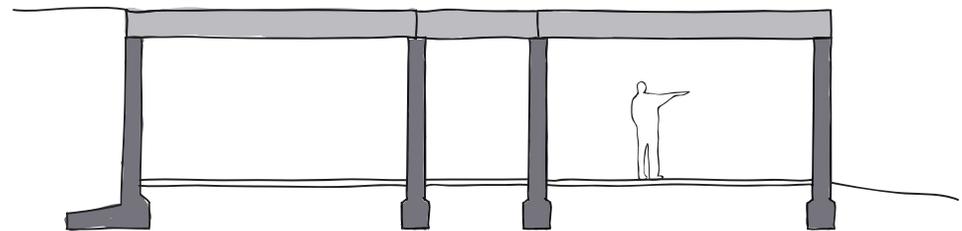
Corte esquemático estructura de pórticos de hormigón armado. Fuente: Elaboración Propia.
